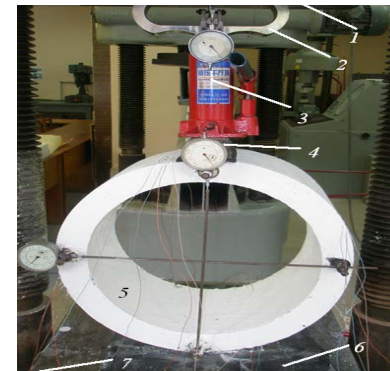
Общий вид испытания СФБ элементов кольцевого сечения: 1 – верхняя опорная плита прессы ПСУ-125; 2 – образцовый динамометр; 3 – домкрат; 4 – металлическая траверса; 5 – опытный образец кольцевого сечения; 6 – резиновый ковер; 7 – нижняя опорная плита прессы ПСУ-125
